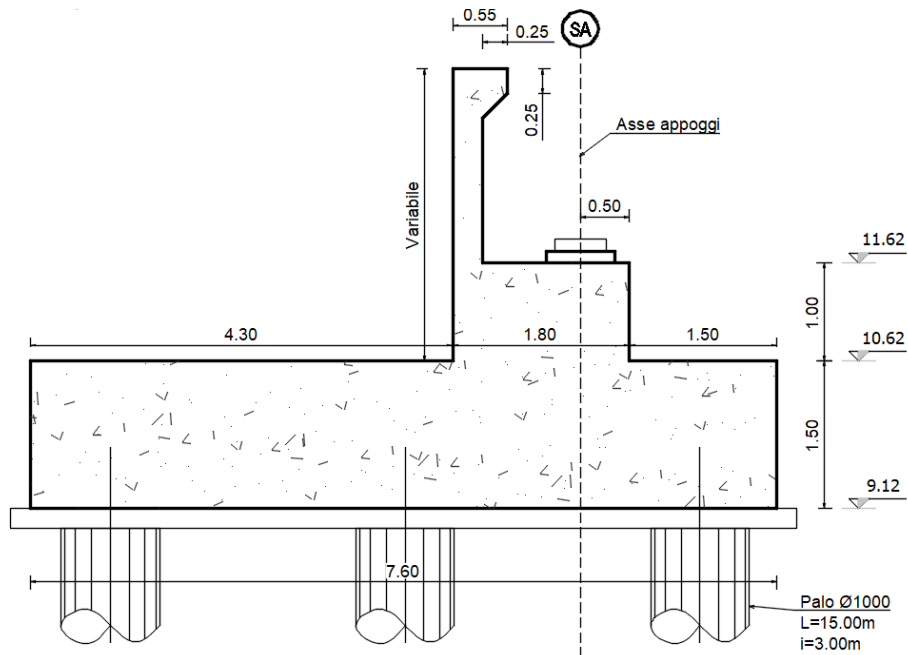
Profilo spalla "SA" lato Asse Principale Direzione Nord
